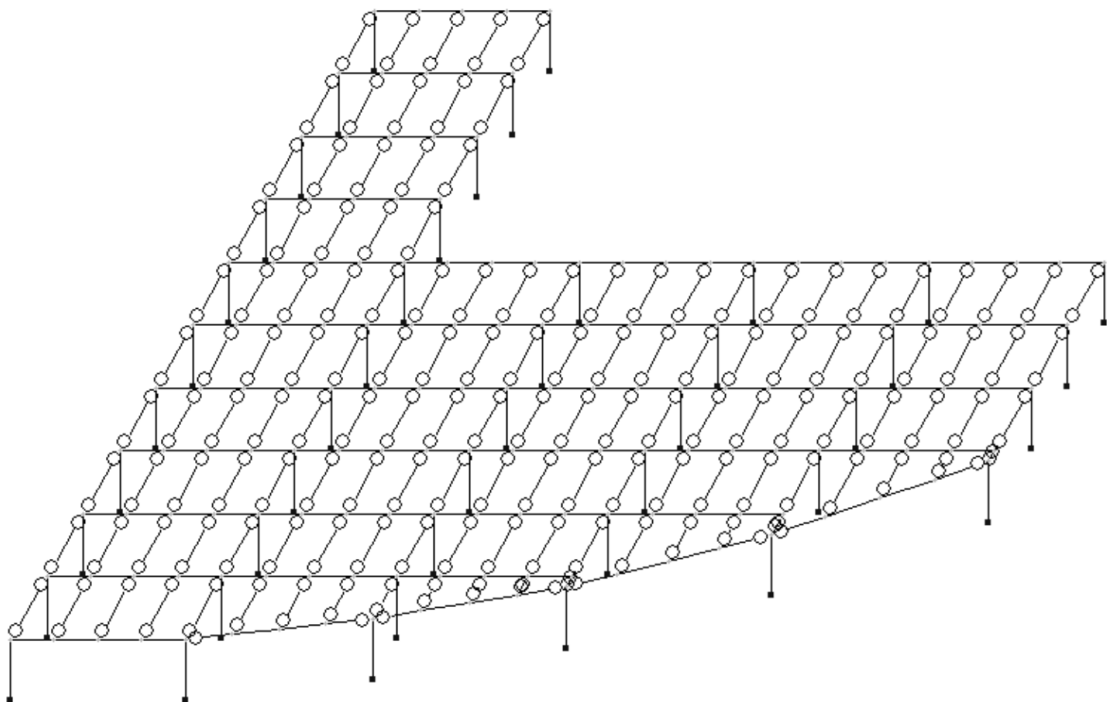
Розрахункова схема каркасу одноповерхової частини будівлі.
